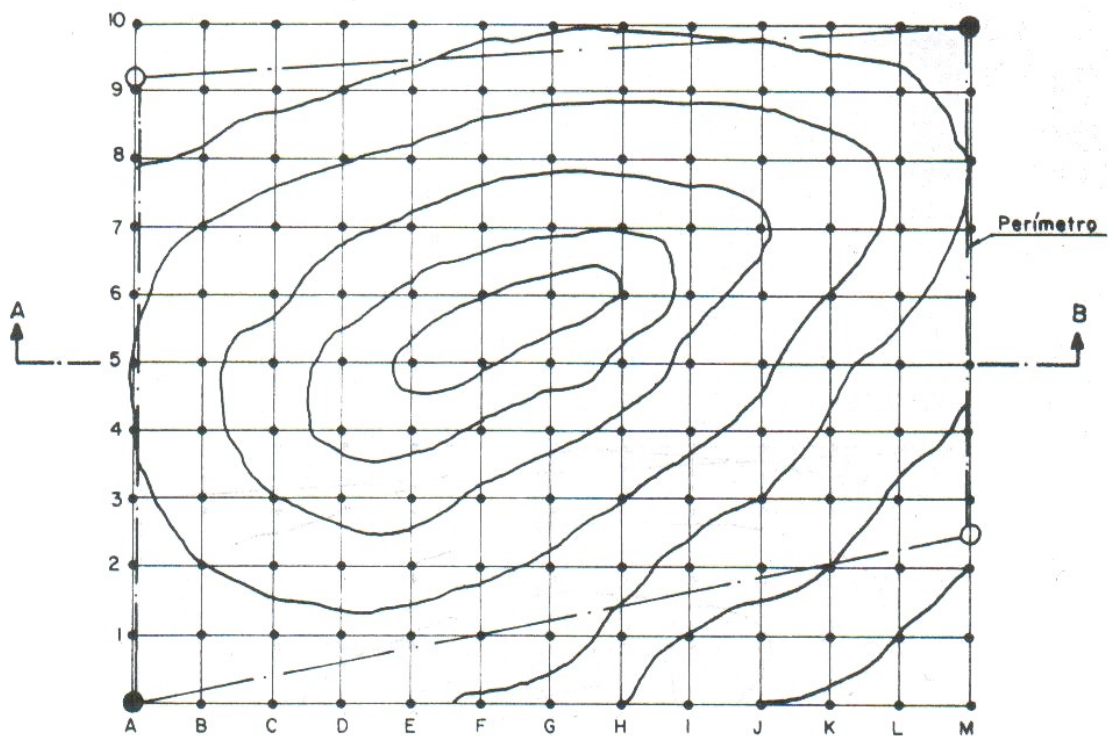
Malla de sondeos para levantamiento geotécnico de bancos
